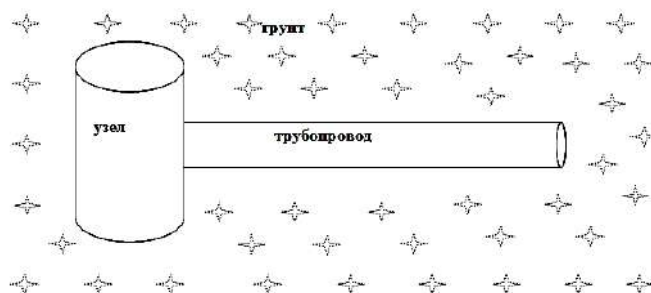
Схема подземных трубопроводов с узловыми соединениями
